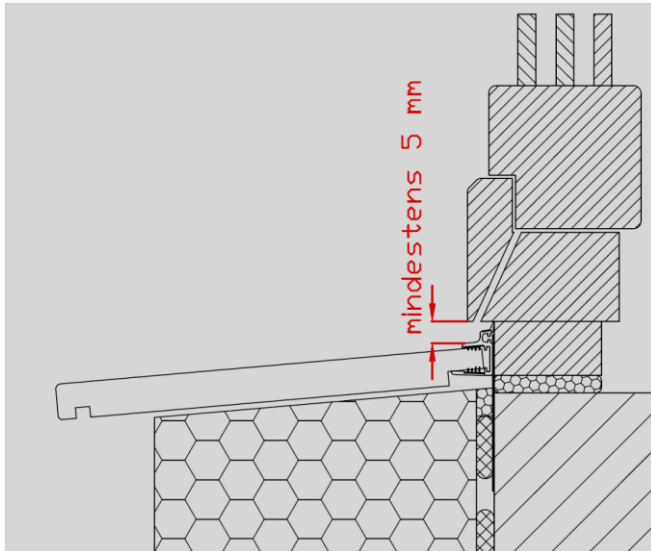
Darstellung eines ausreichend hohen Spalts zur Wasserabführung
